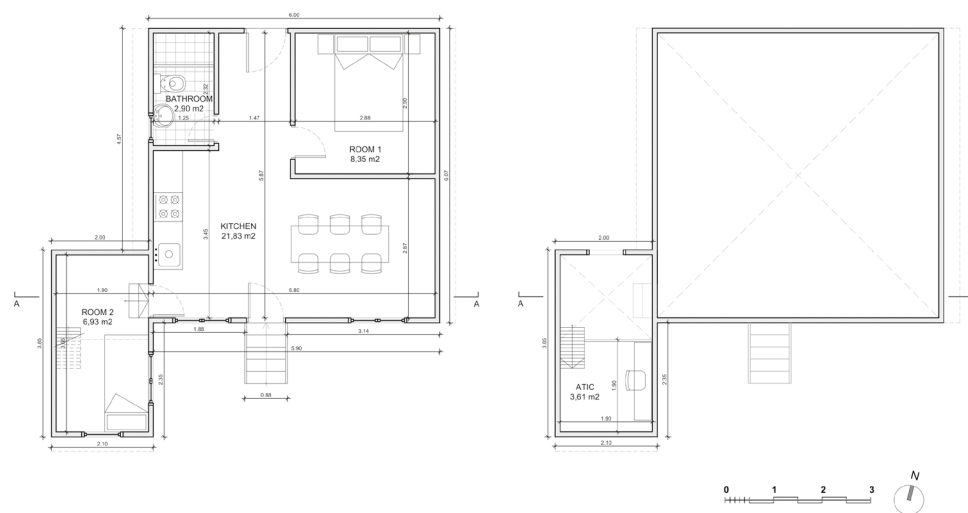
Planos vivienda I. Izquierda: Planta baja. Derecha: Primer piso
